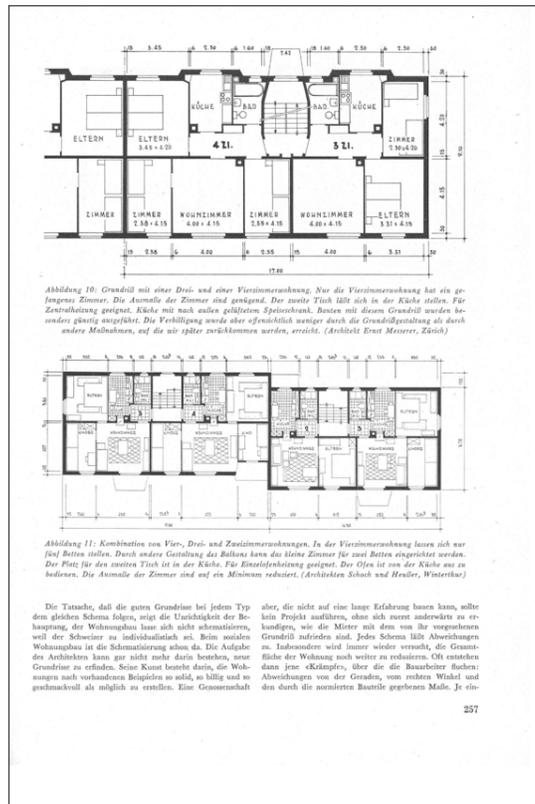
Der schematische Grundriss Zeitschrift "das Wohnen" 1953. Autor: Gts
